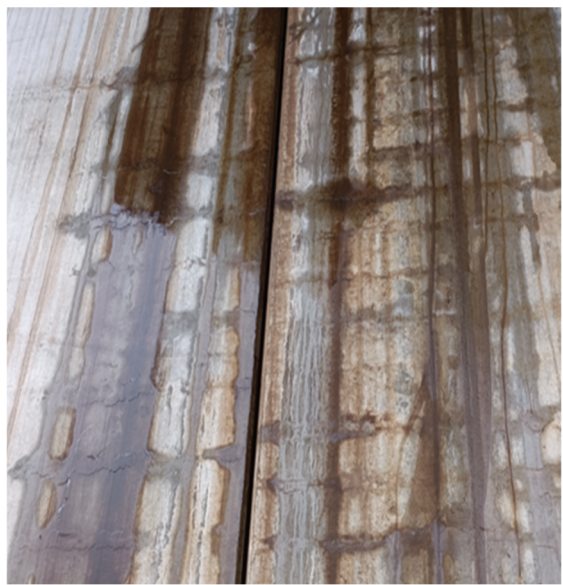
Manchas puntuales de óxido en el muro del Estribo 2
